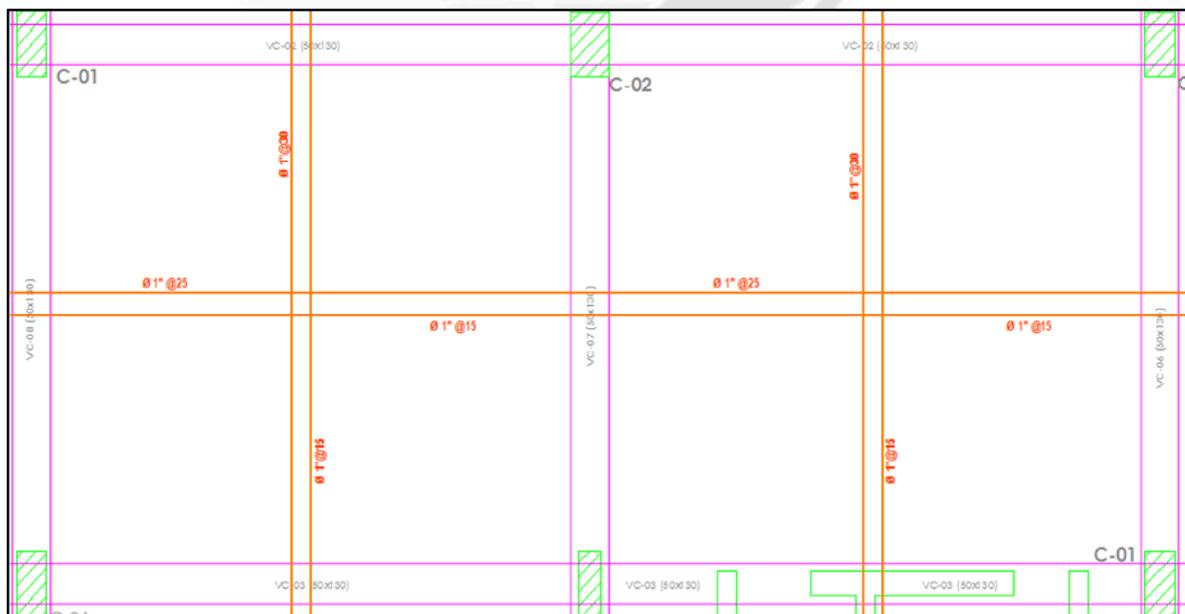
Distribución Final del Refuerzo para la Platea de Cimentación en uno de los Paños.
